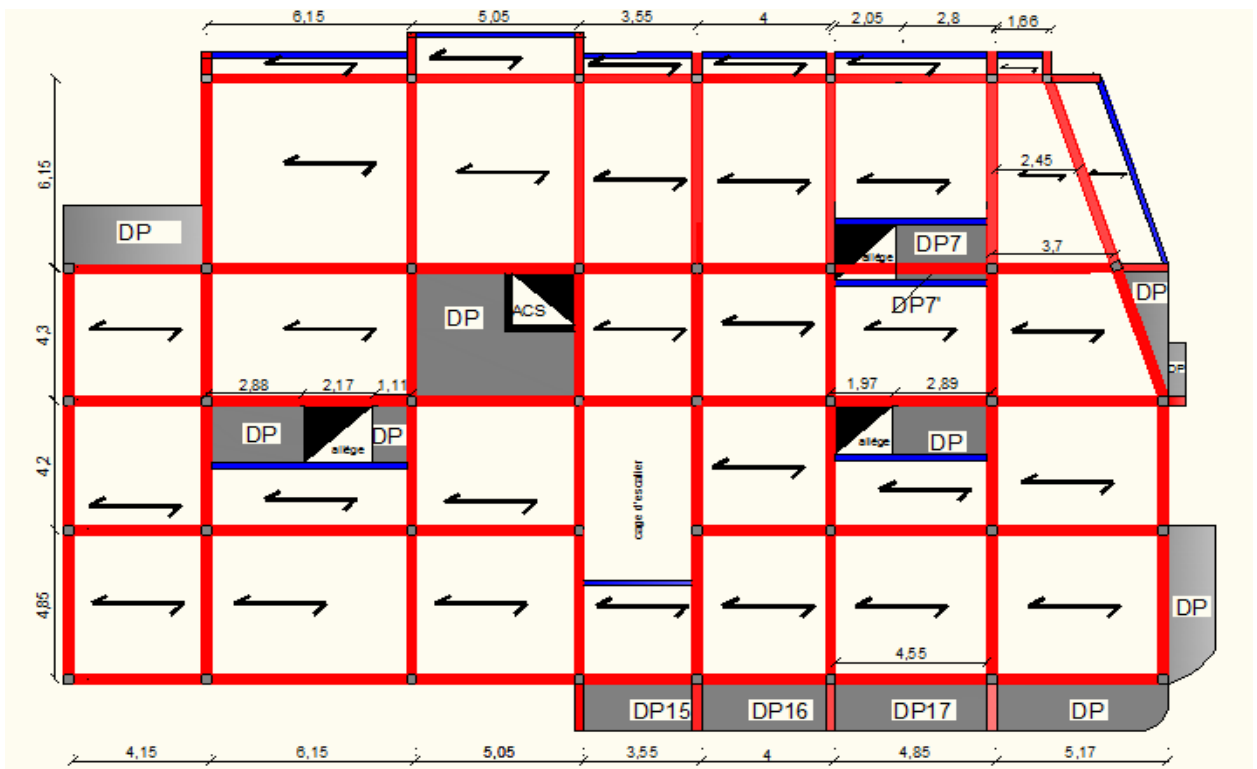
Disposition des poutrelles (premier niveau duplexe).
